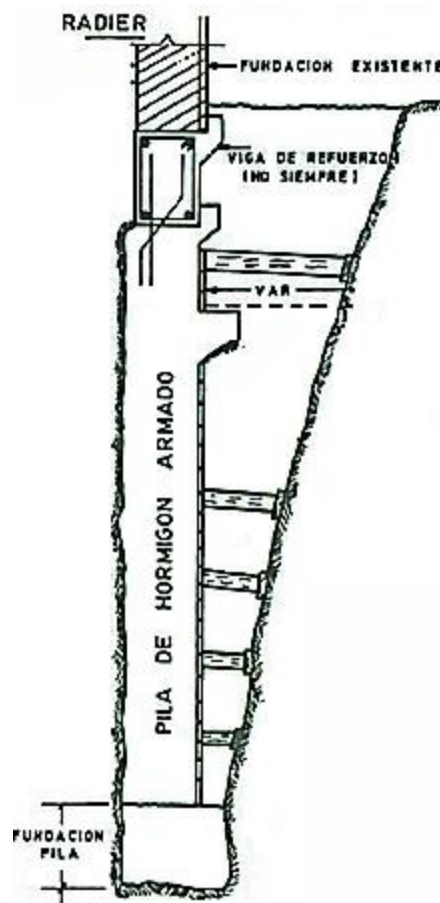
Ejemplo de Viga de Refuerzo en Pila de Socialzado. Ortigosa y Retamal (1994),
